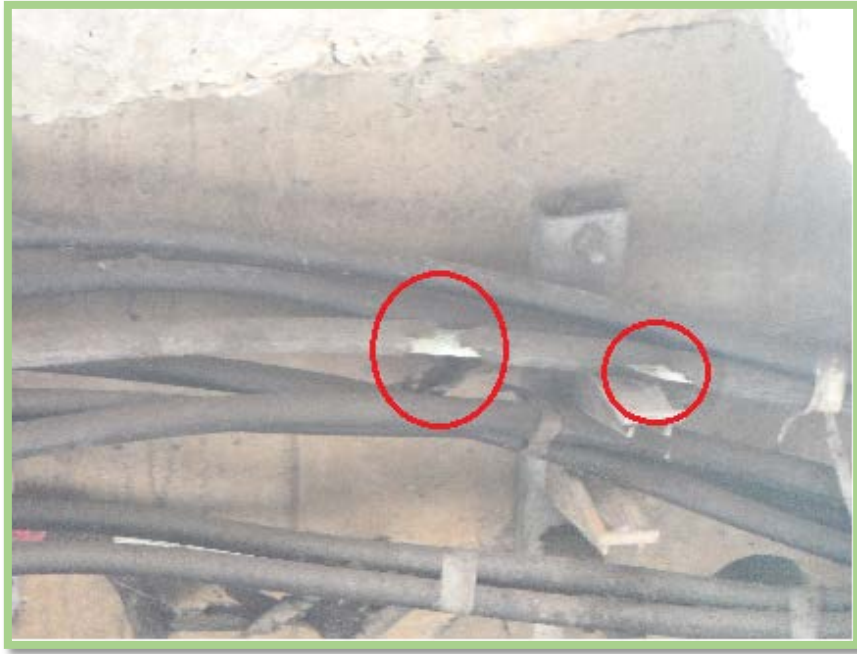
Fallas de aislamiento, cableado de baja tensión ST-19.
